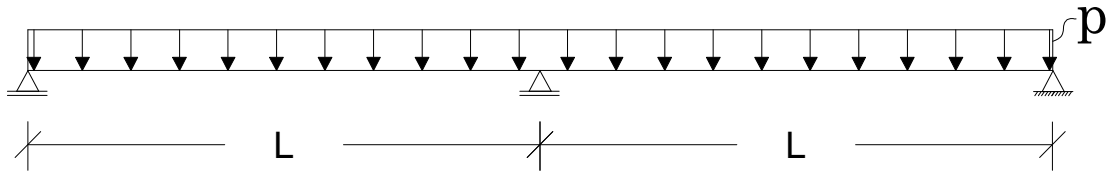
Modelo de calculo para as vigas da modelação da análise parametrica
